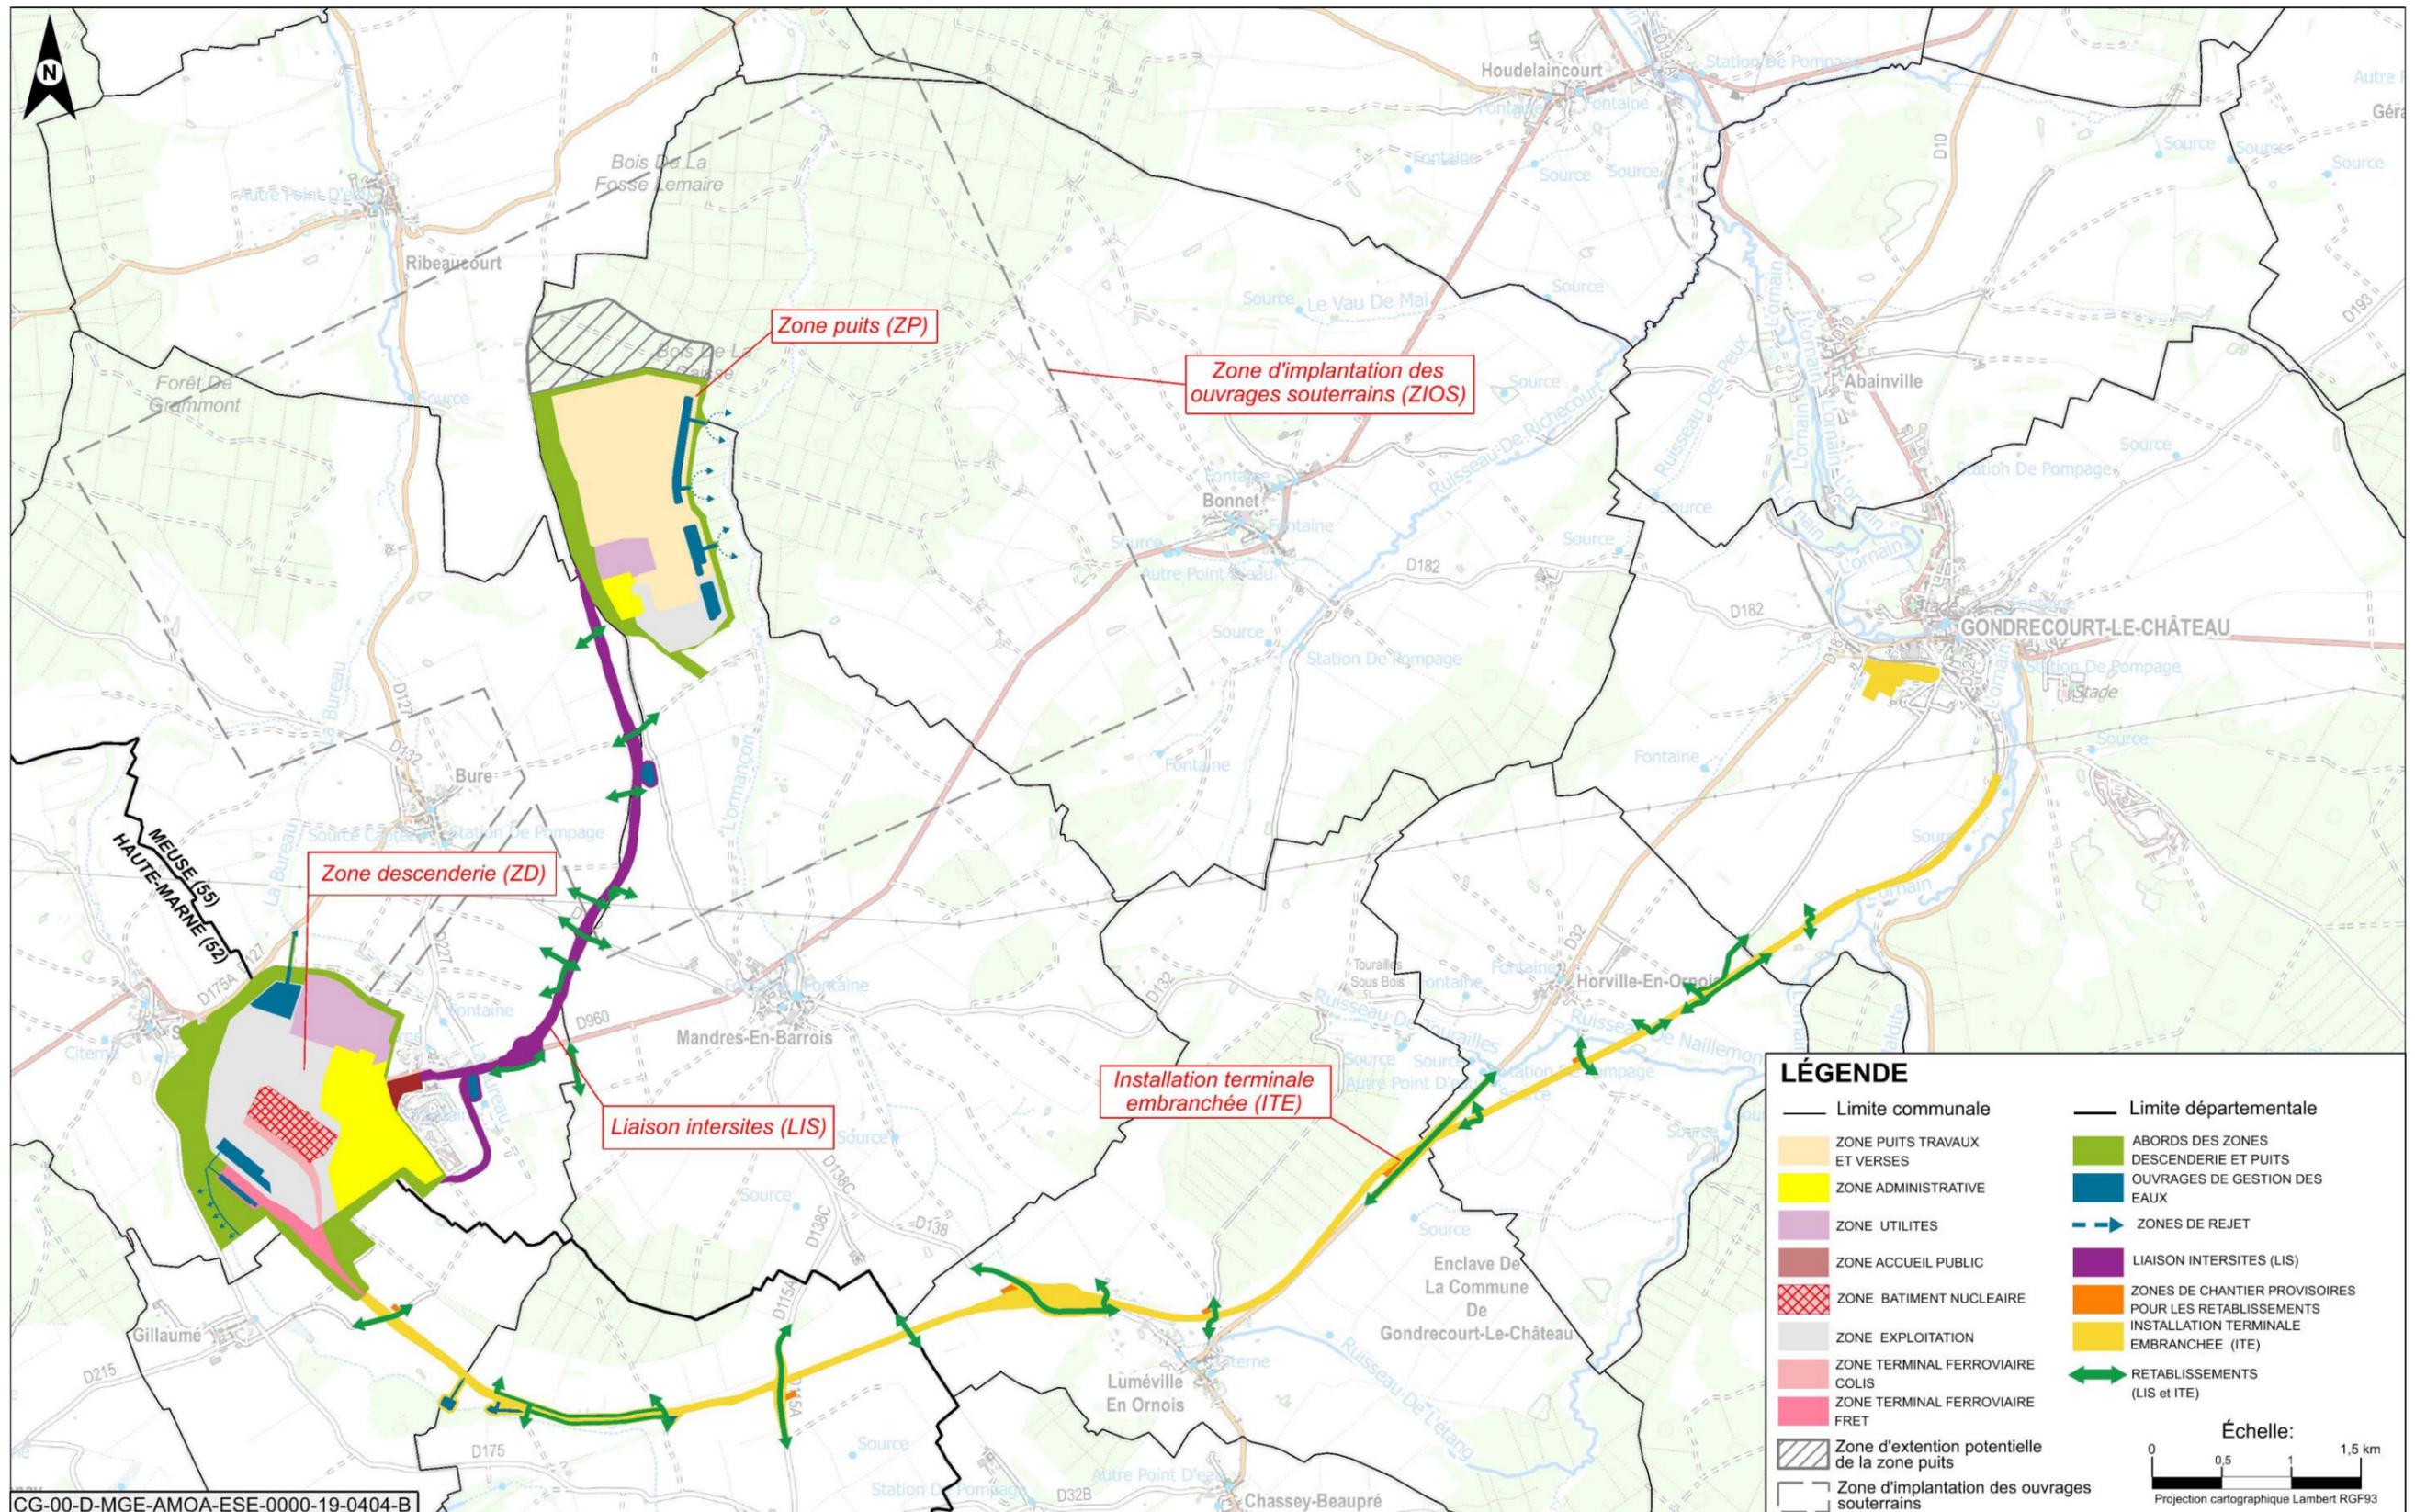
Plan général des travaux du centre de stockage Cigéo
